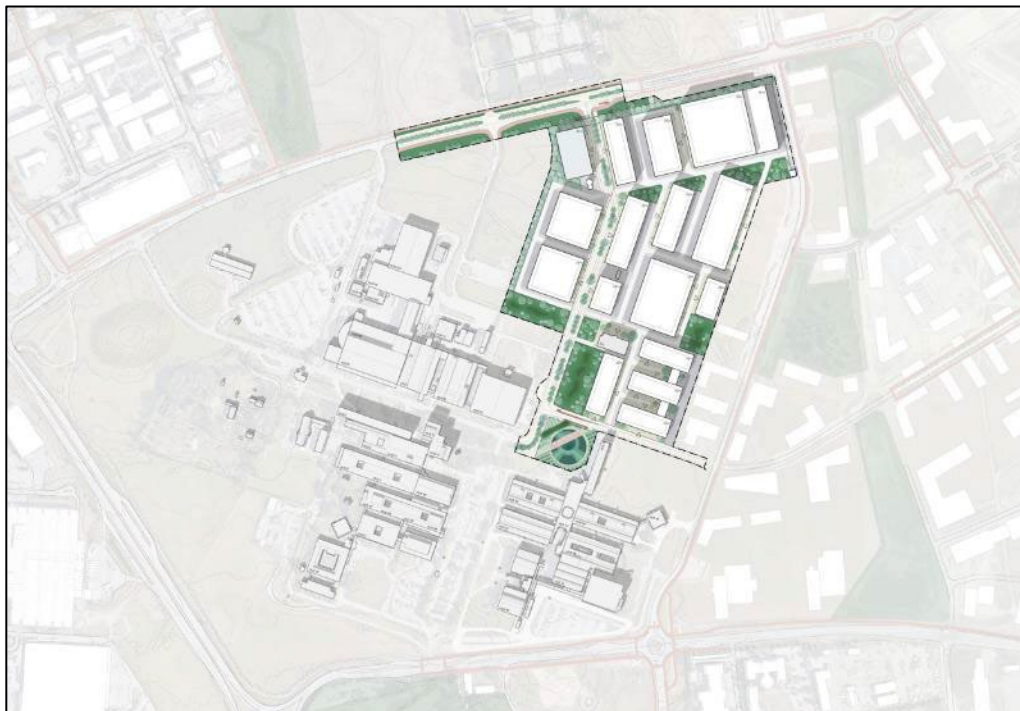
Illustrationsplan över en möjlig utbyggnad inom planområdet. Illustration: Mandaworks.
